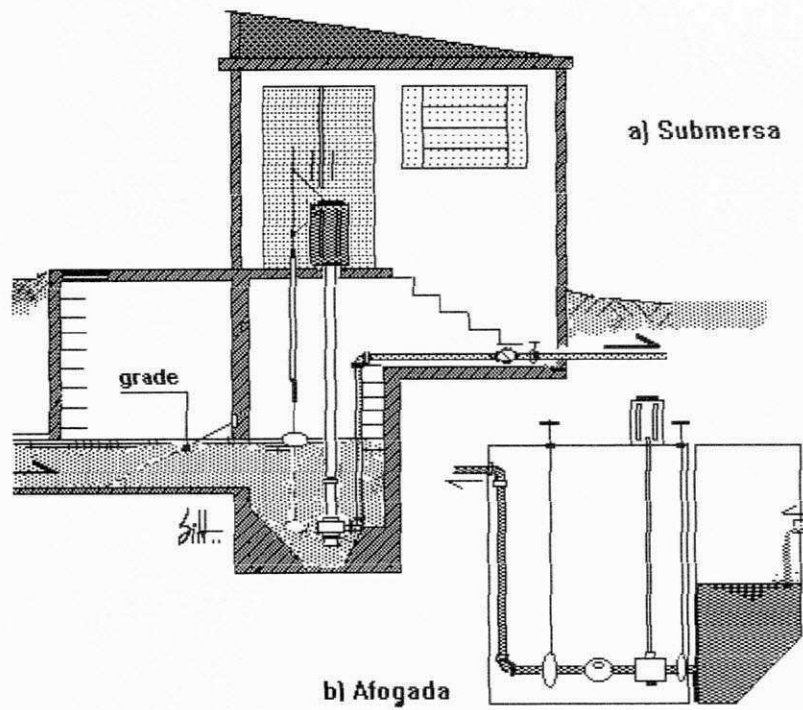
Elevatórias com bombas de eixo vertical
